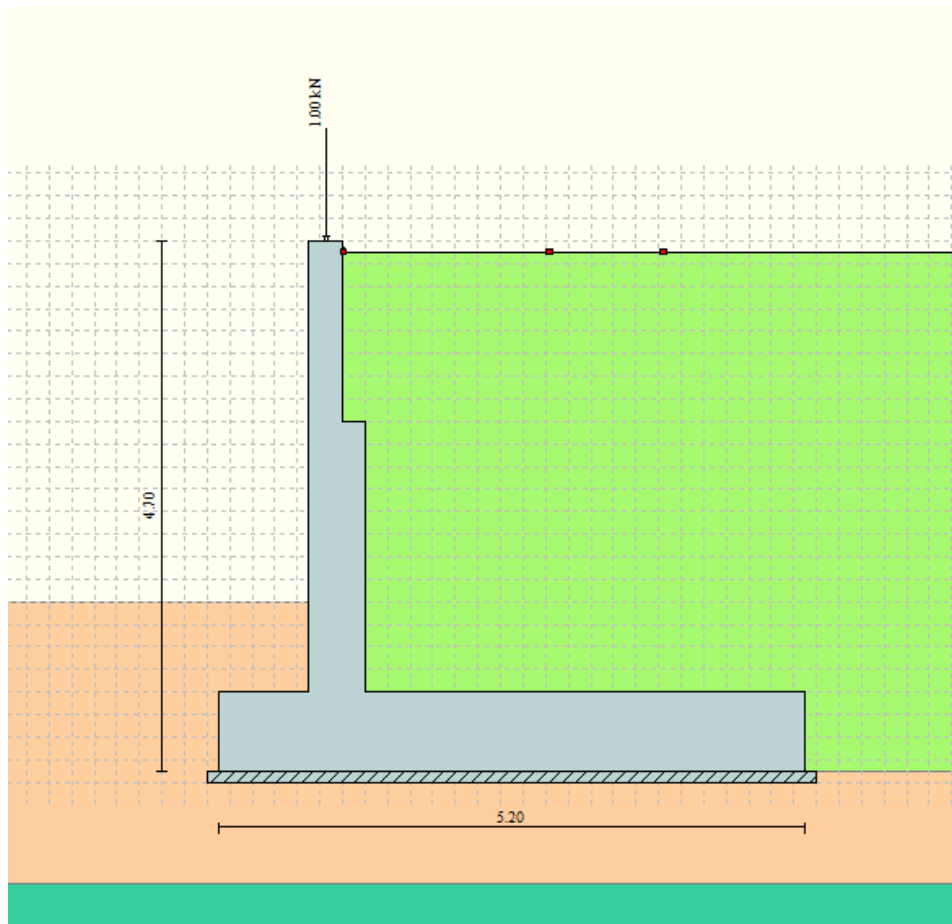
Applicazione dei carichi: Peso parapetto
